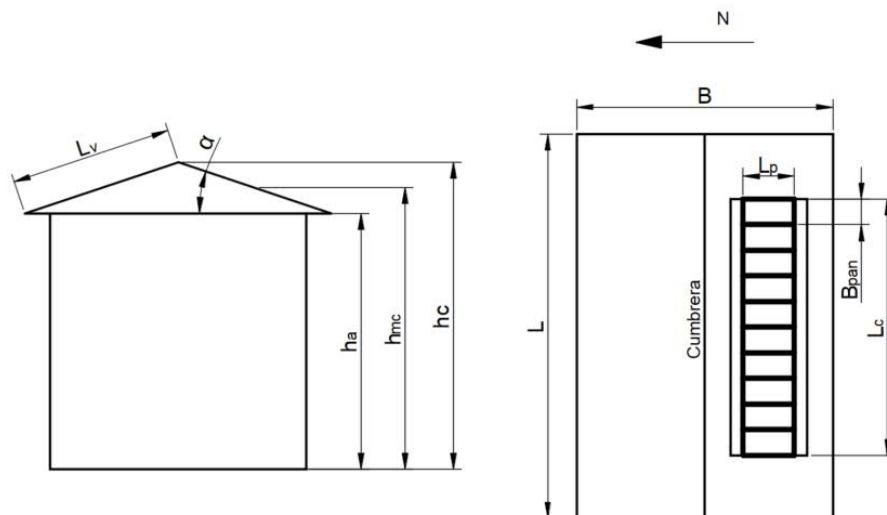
Geometría edificación y arreglo de paneles coplanares.
